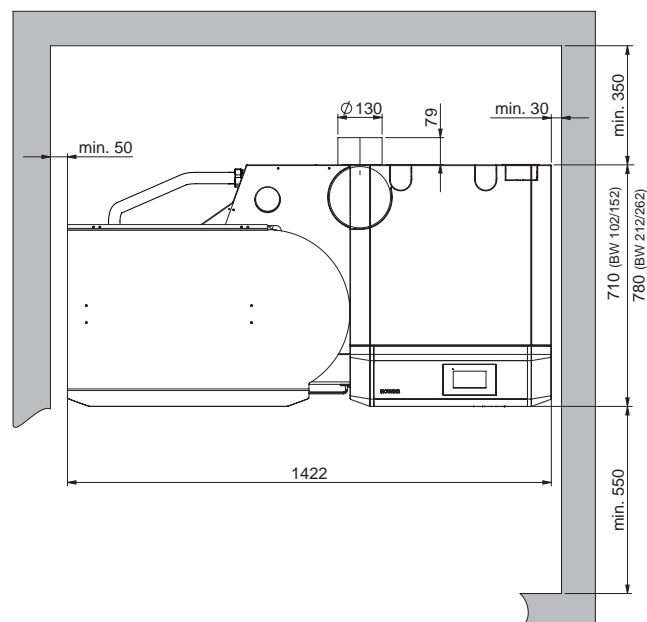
BioWIN 2 Hybrid – vista dall'alto
